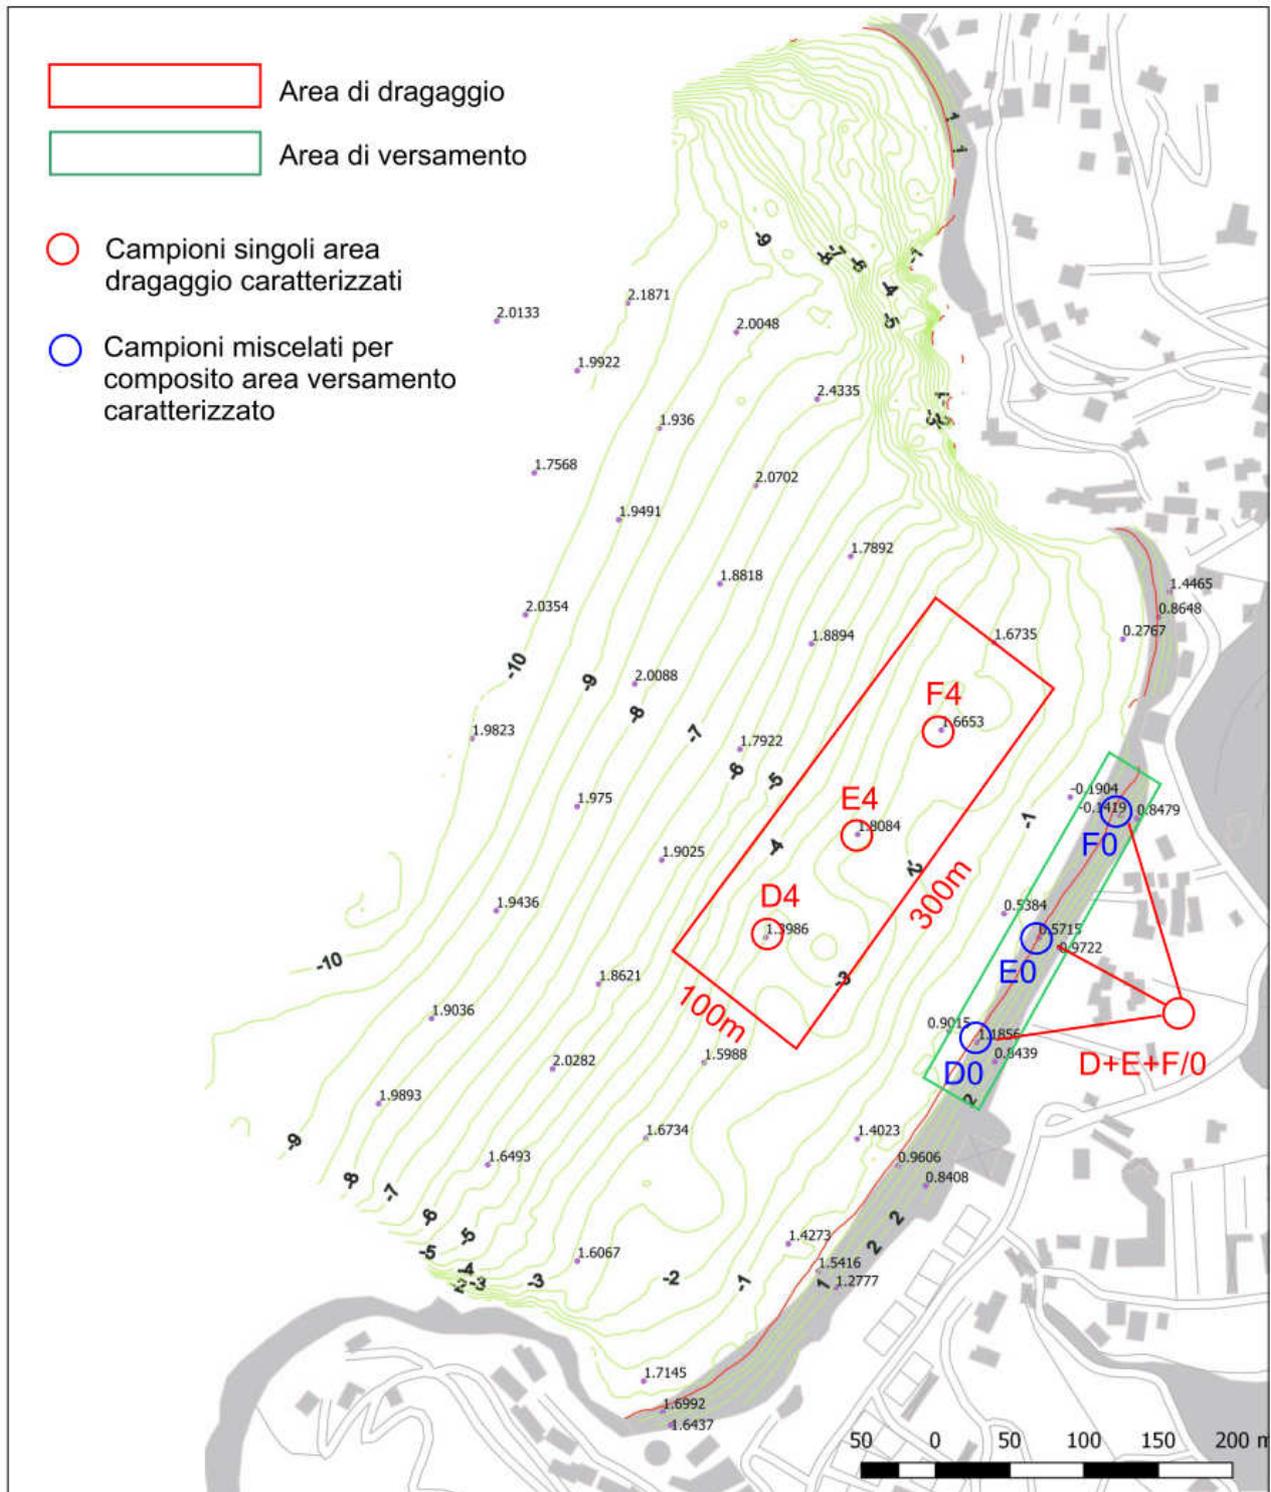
L'intervento di riprofilatura: Planimetria generale, con indicazione delle batimetriche, della linea di riva e dei dati sedimentologici dei campioni di sedimenti di fondale raccolti e analizzati (v. Allegato 2). In rosso la zona di prelievo, in verde la zona a terra oggetto del versamento.
